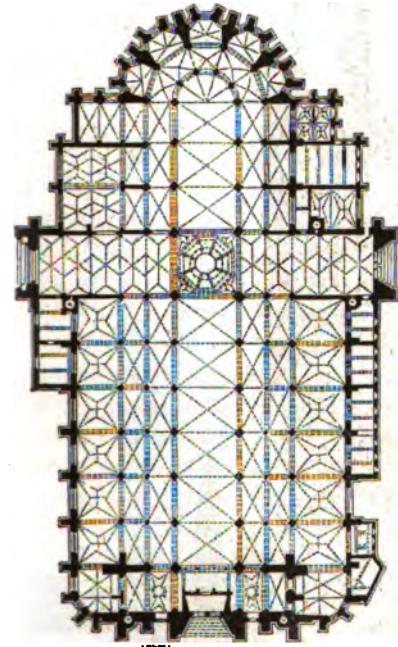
Grundriss der Kathedrale von Antwerpen.
